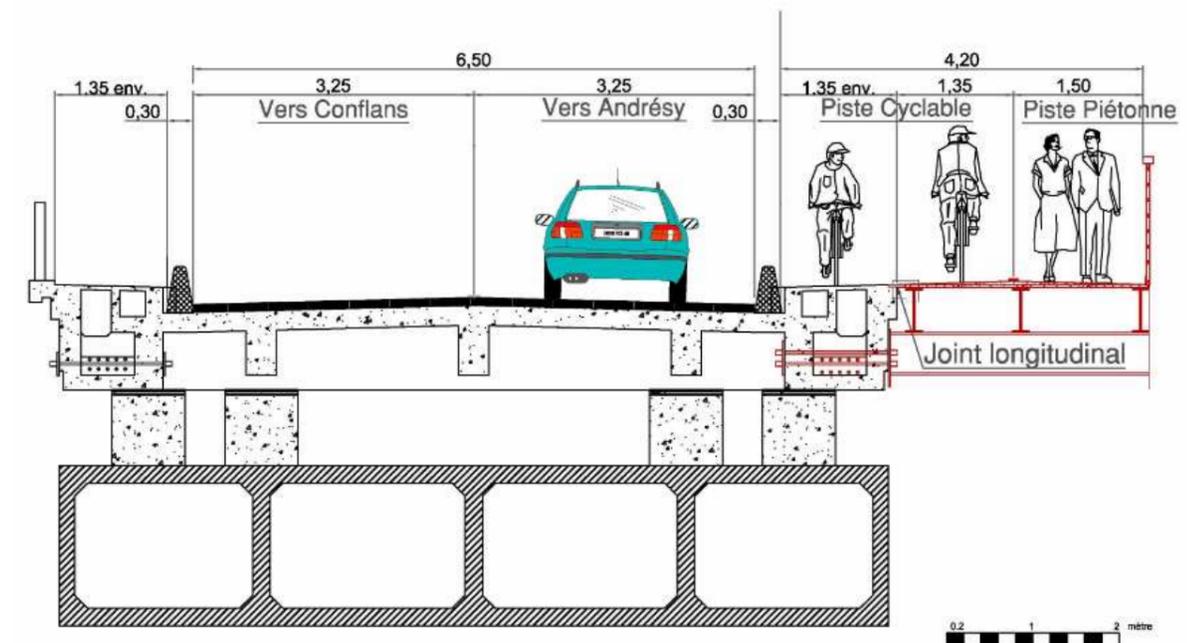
Coupe de principe de la passerelle accrochée à l'ouvrage existant de franchissement de l'Oise.
